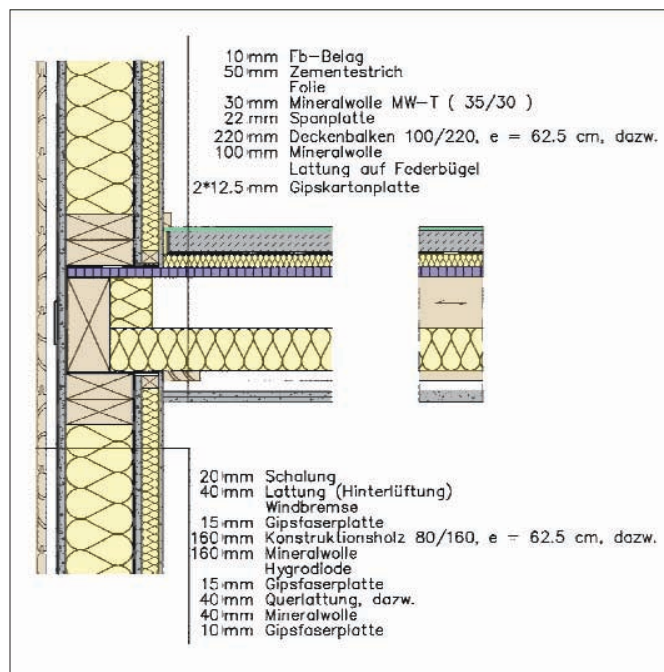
Anschluss eines Deckenbauteils an eine raumabschließende Wand nach [24]
